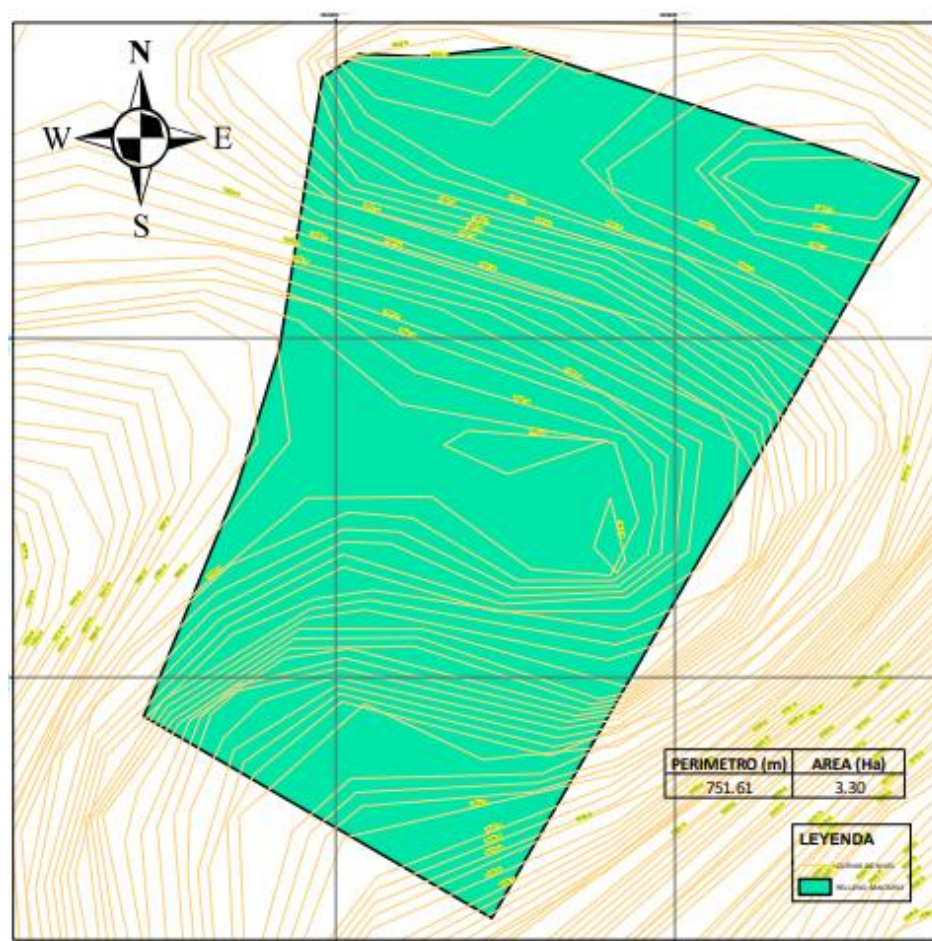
Plano de levantamiento topográfico de la alternativa 2: Sector Yunguilla.
